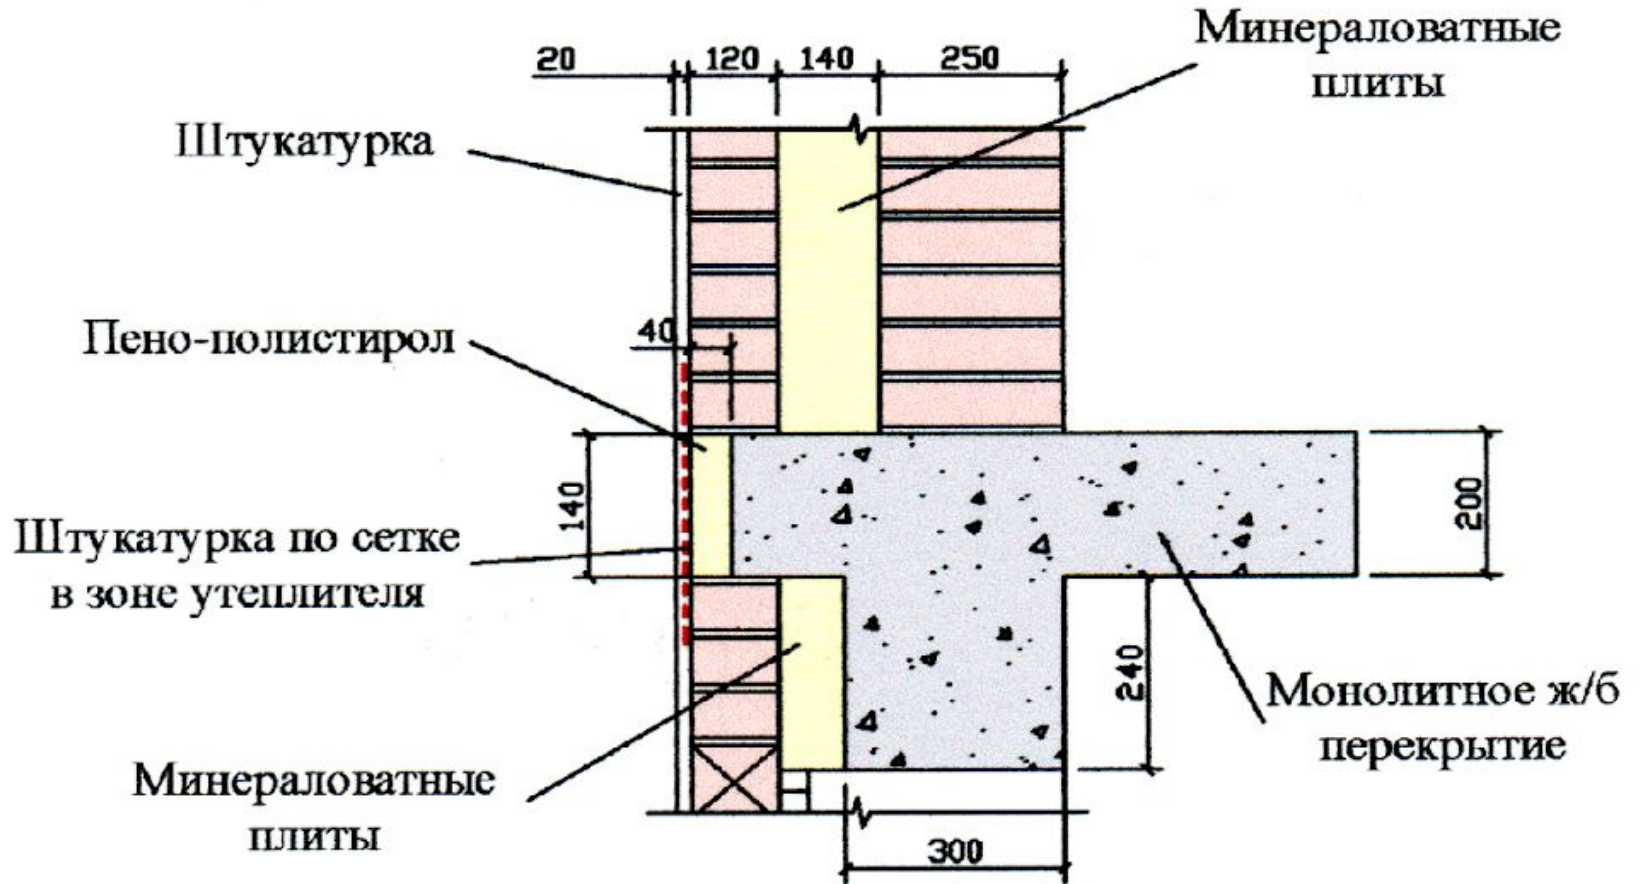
Узел сопряжения лицевого слоя кладки с плитой перекрытия.
